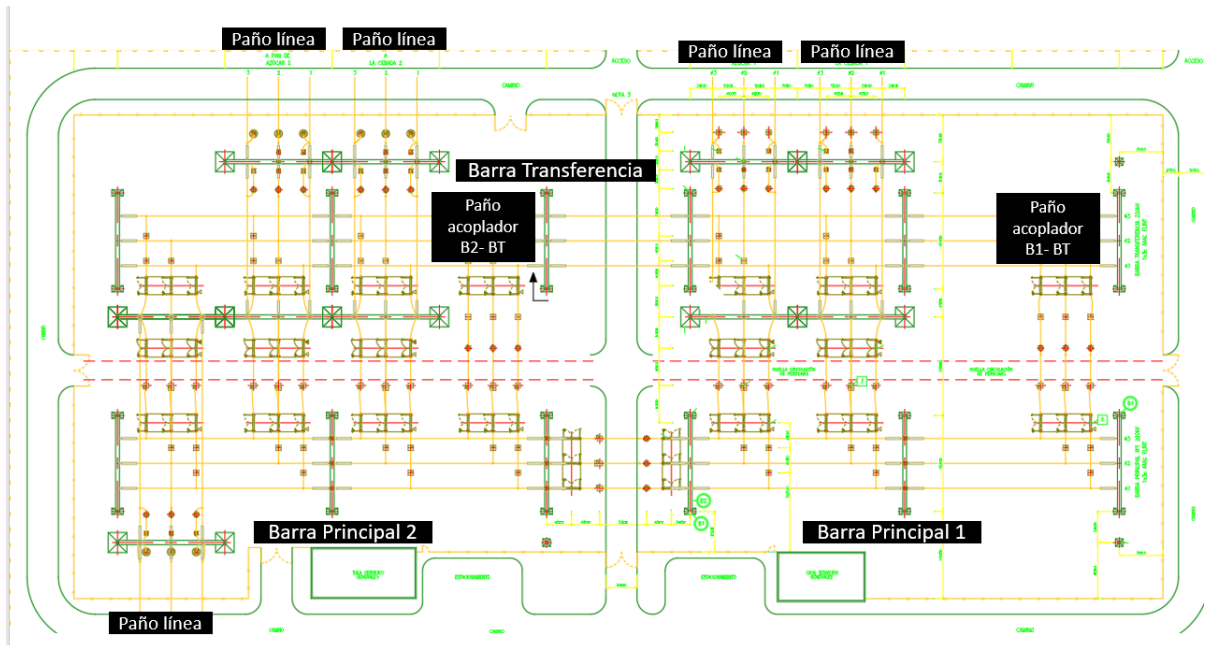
Ejemplo de un diagrama de planta de una subestación en configuración doble barra mas transferencia
